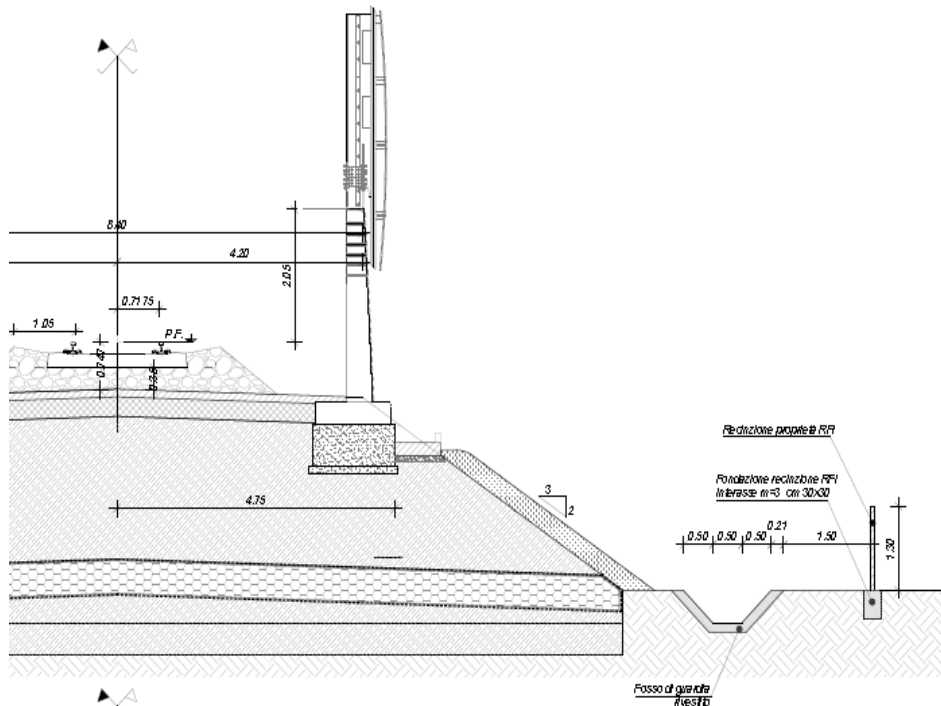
Dettaglio alla base del rilevato ferroviario senza pista di servizio
